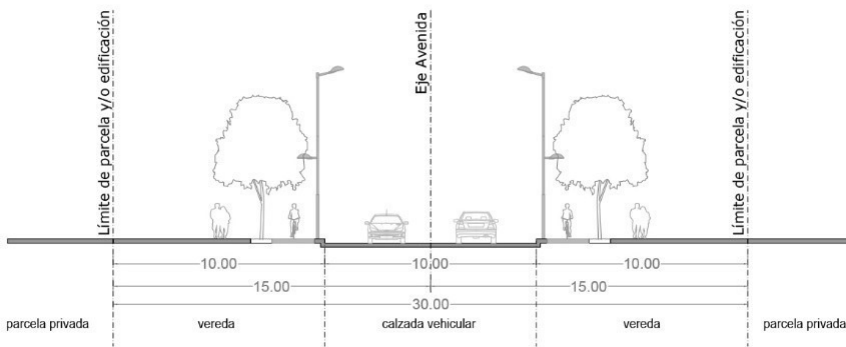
Sección transversal de Vías Avenidas Tipo 3.
